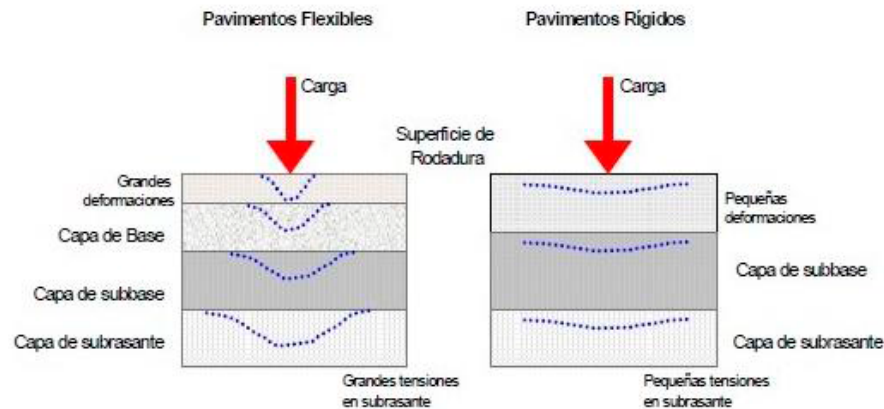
Carga en pavimentos rígidos y flexibles.
